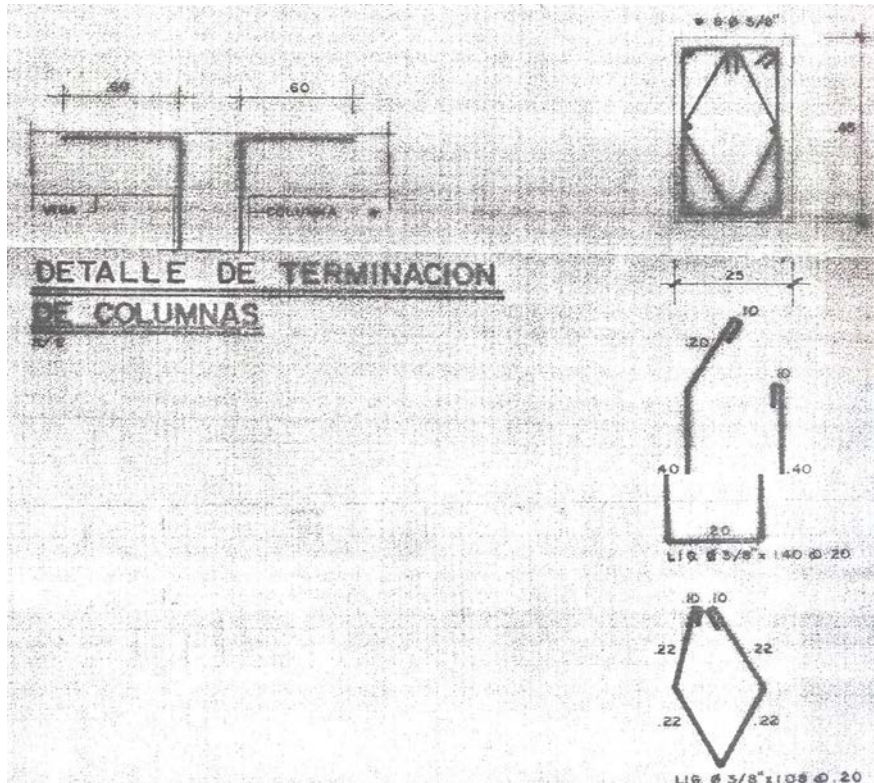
Detalles de columnas. Tipo STAC
